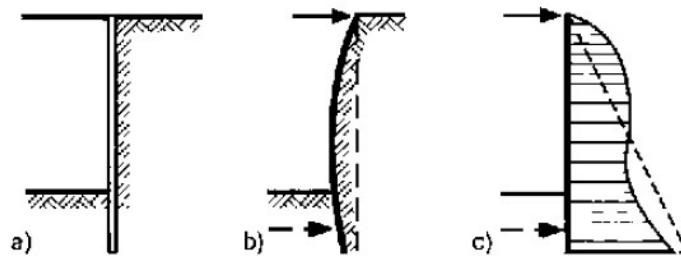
Cortina com um nível de apoio localizado no topo. a) Seção transversal da escavação; b) Deformação da cortina; c) Distribuição das tensões horizontais, adaptado de Weissenbach et. al., 2002
